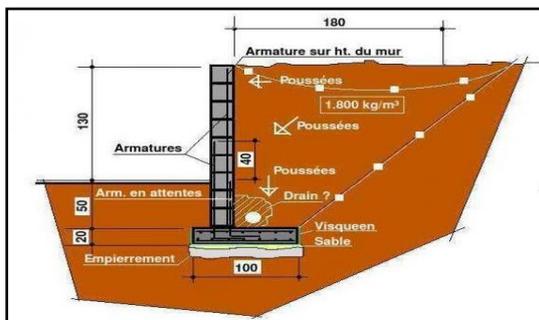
Détails technique d'un mur de soutènement \_ Figure 114 : La mise en place d'un mur de soutènement
